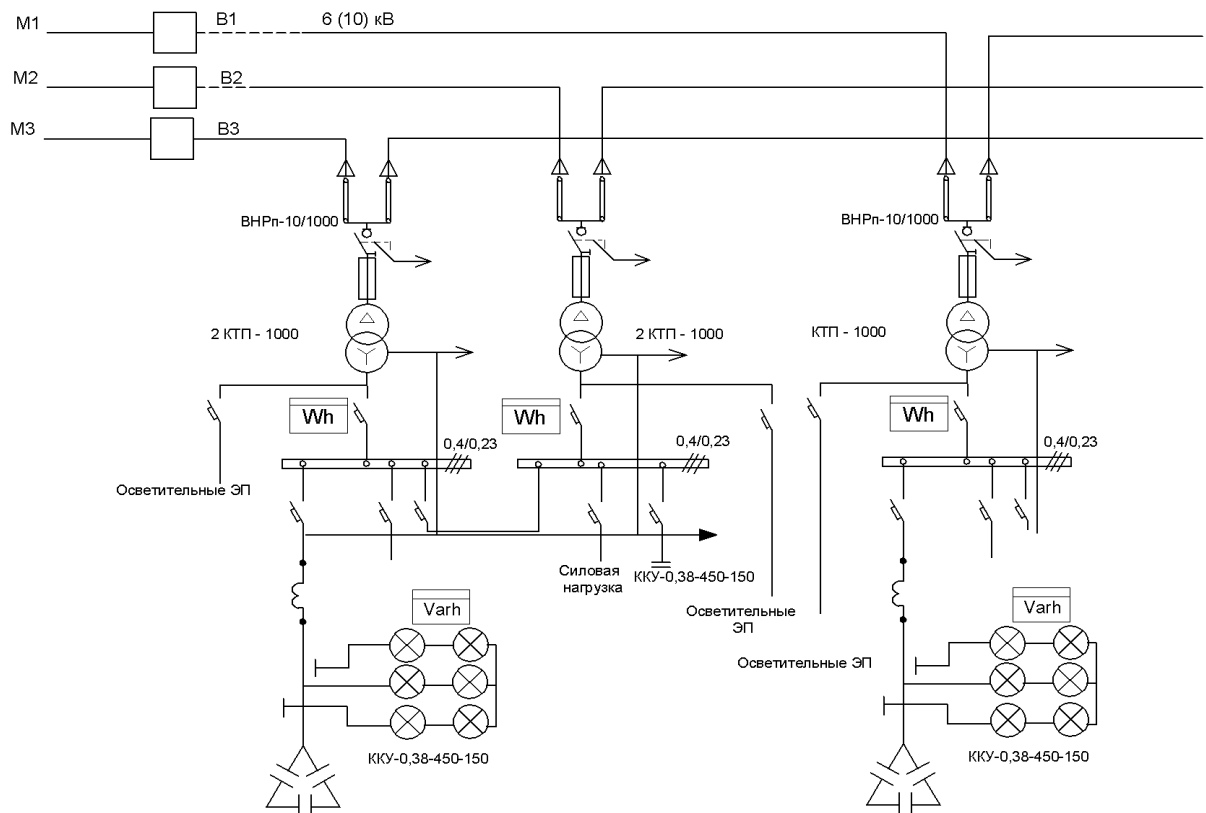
Схема совместного питания силовой и осветительной нагрузки от КТП с КРМ в сети до 1 кВ
